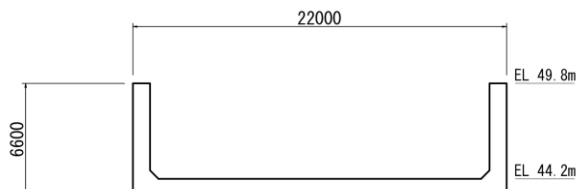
輪谷貯水槽（東側） 平面図 (単位: mm)
